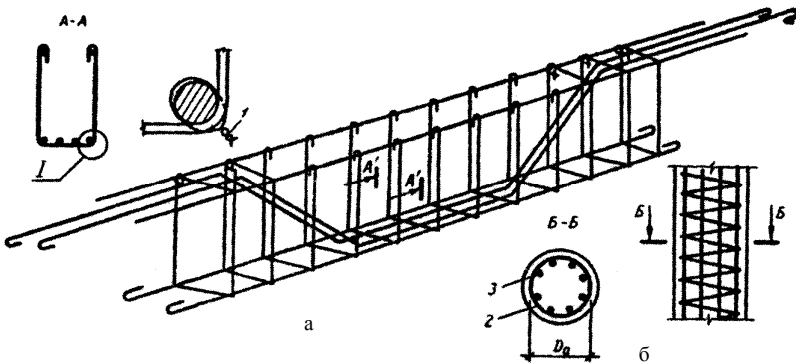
Арматування конструкцій окремими стержнями:
